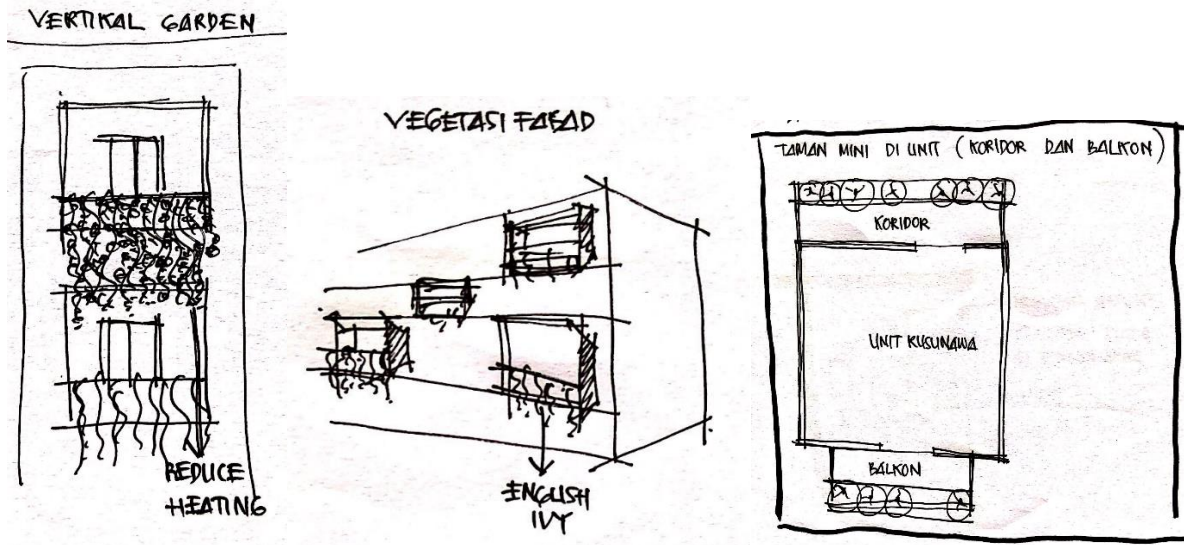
Vertikal Garden sebagai Fasad
